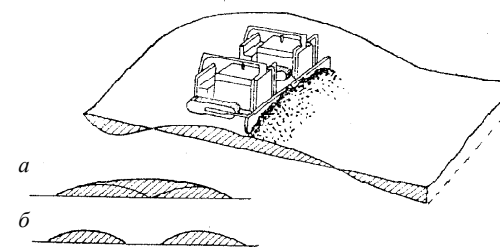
Перемещение грунта двумя бульдозерами, идущими рядом (спаренная работа):
